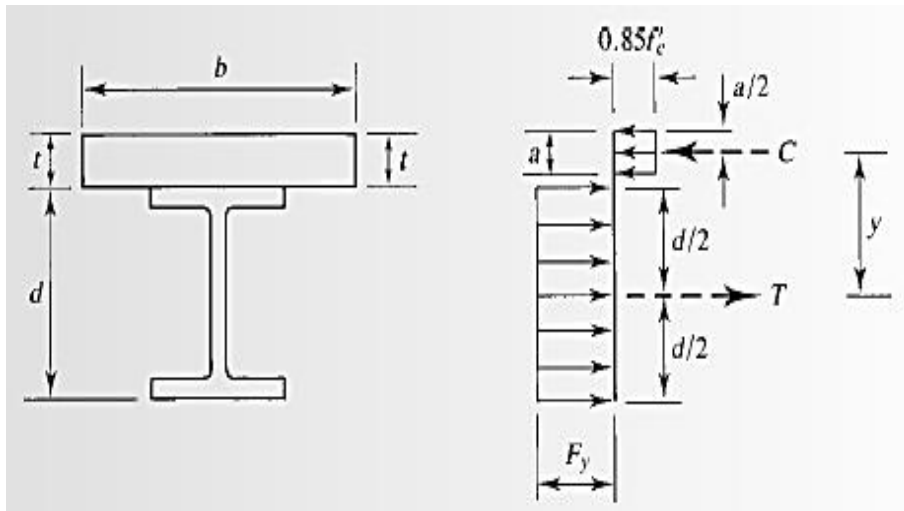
Acción compuesta del perfil de acero y la losa de concreto
